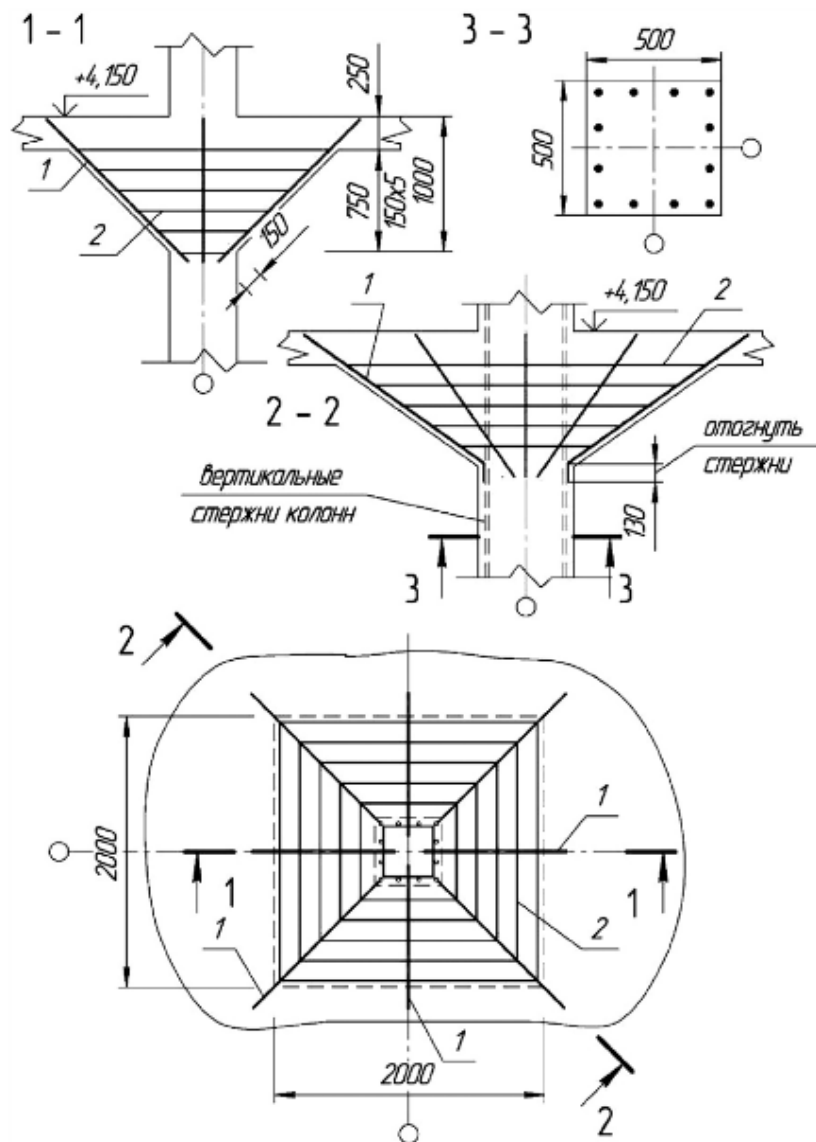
Схема армирования капители в виде четырехгранной пирамиды
